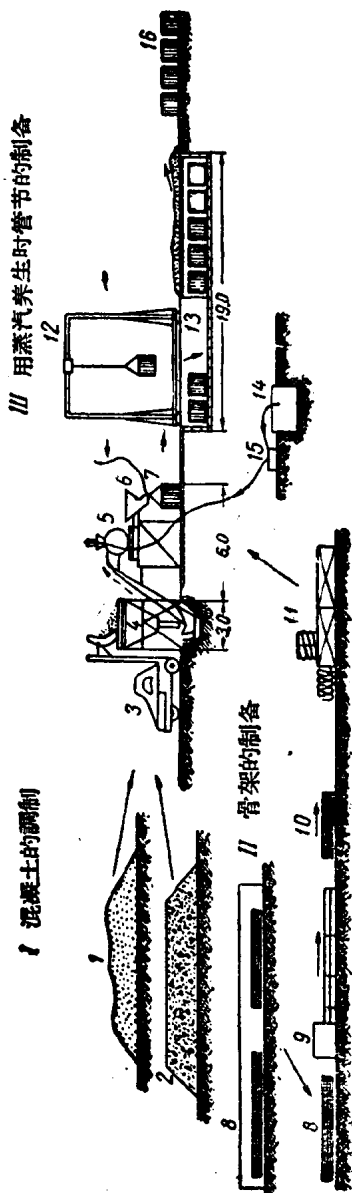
制备鋼筋混凝土涵洞管節技術操作圖式
